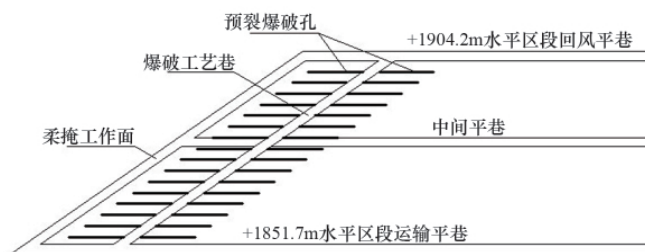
柔掩支架采煤法伪斜上山预裂爆破工艺巷炮孔布置立面图
